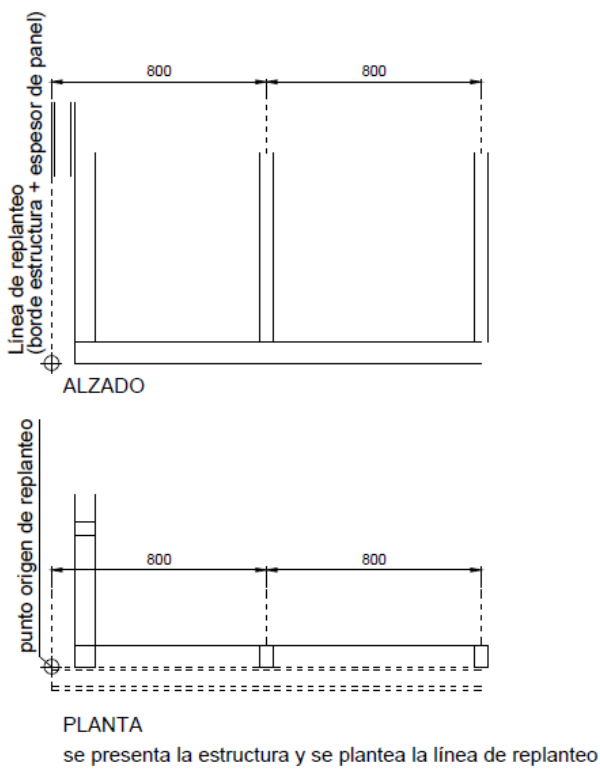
Replanteo de la estructura y de la primera hilada de paneles SATE o WALL.
